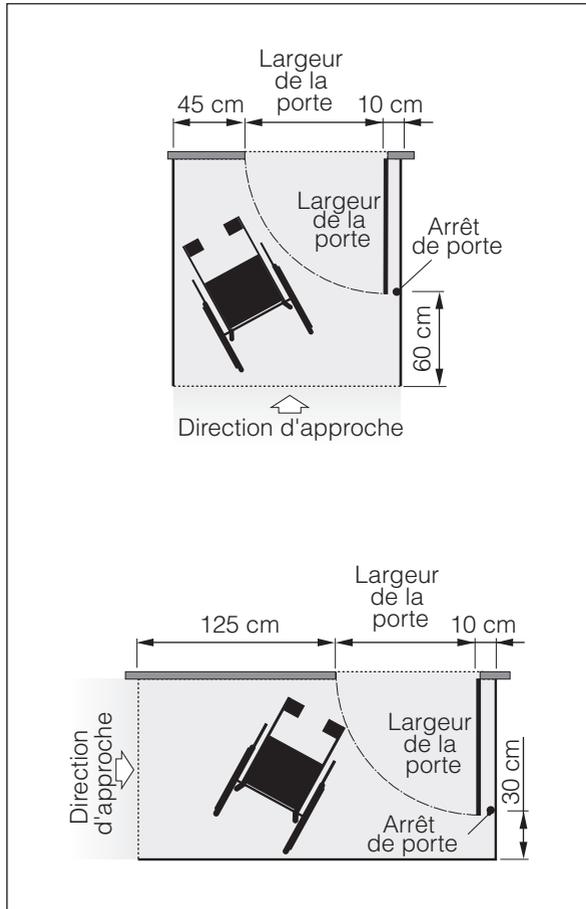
Les dimensions minimales d'une plate-forme pour permettre d'ouvrir une porte.
